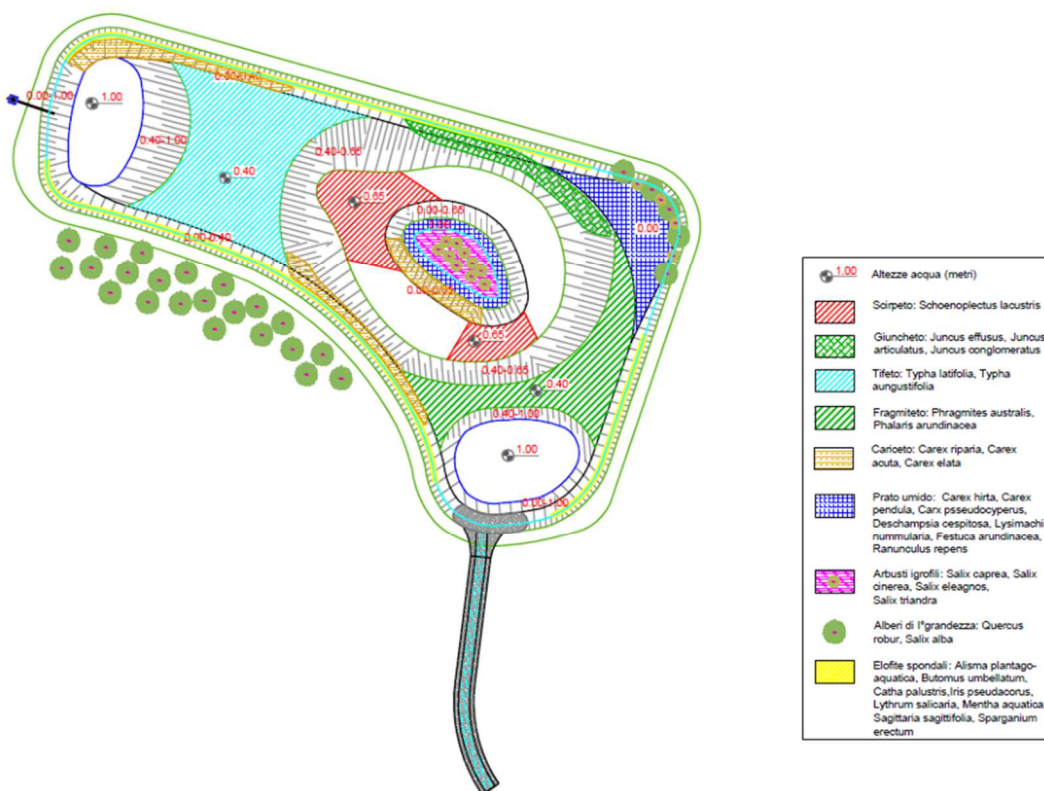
Planimetria della zona umida presente all'interno della cassa di espansione
